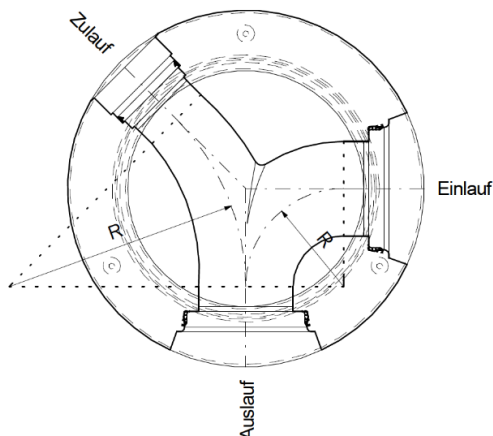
CENTUB® Massschachtunterteil Einlauf und Zulauf
